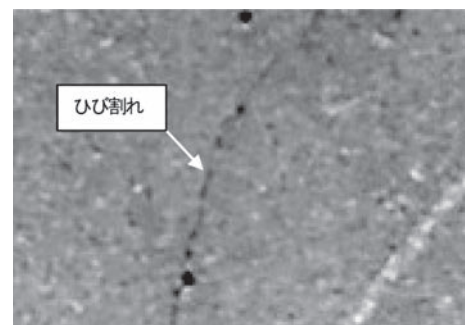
ひび割れ部拡大 (撮影距離4.0m)
